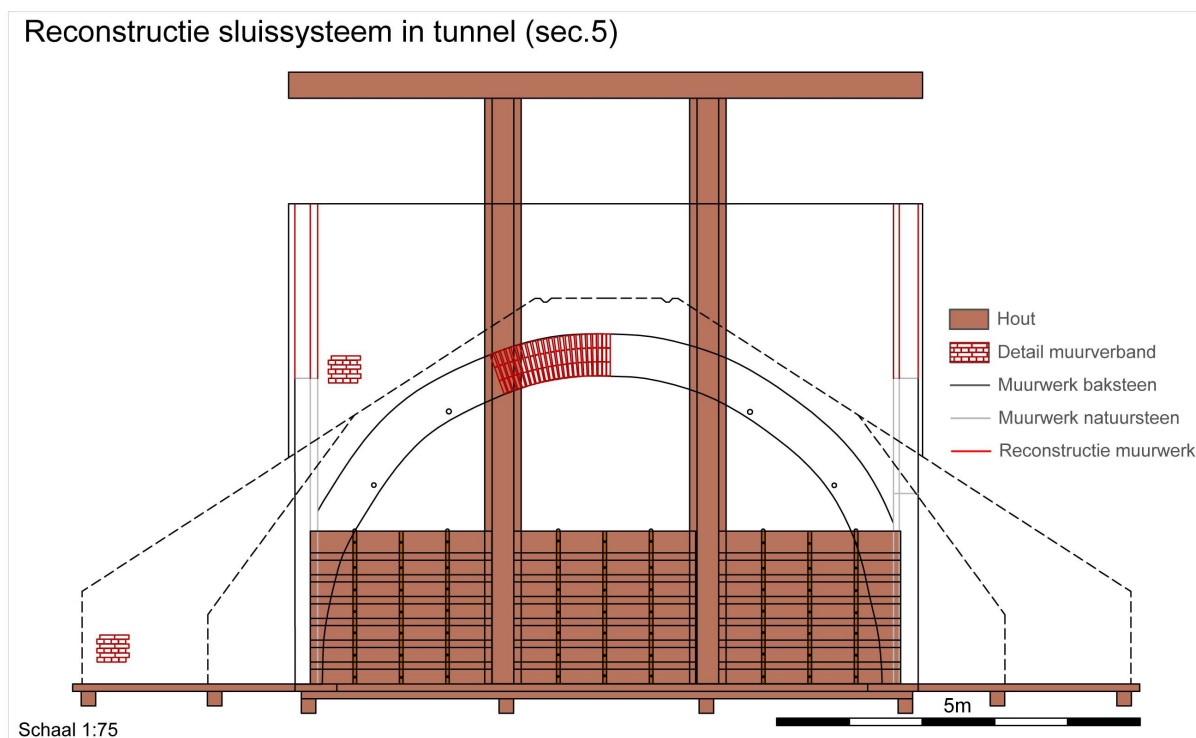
Reconstructie sluissysteem in tunnel (excl. bovenslagbalk, windassen en dakconstructie)
